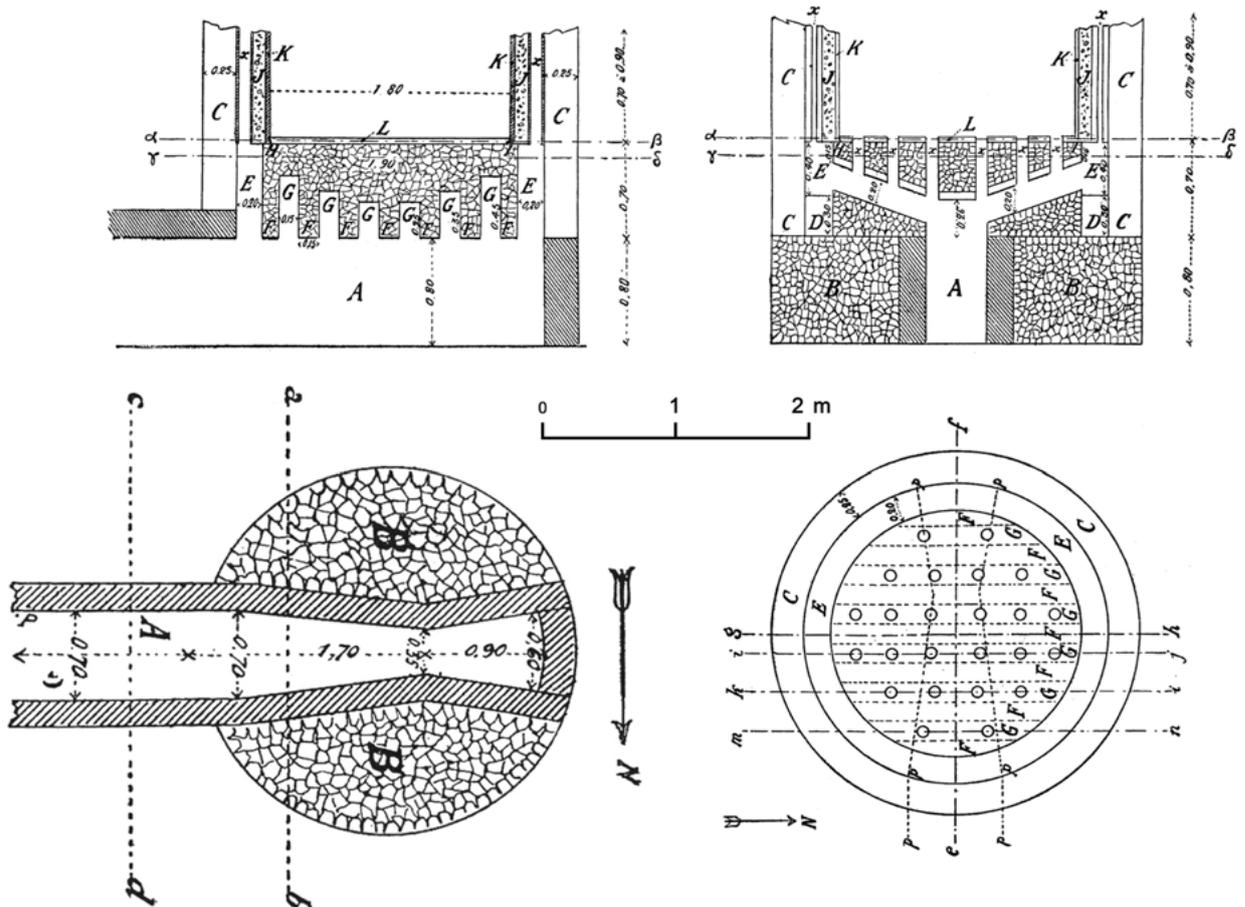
Lezoux. Brennöfen. Oben: Längs- und Querschnitt. Unten: Grundriss der Substruktion und in Höhe der Brennplatte.
